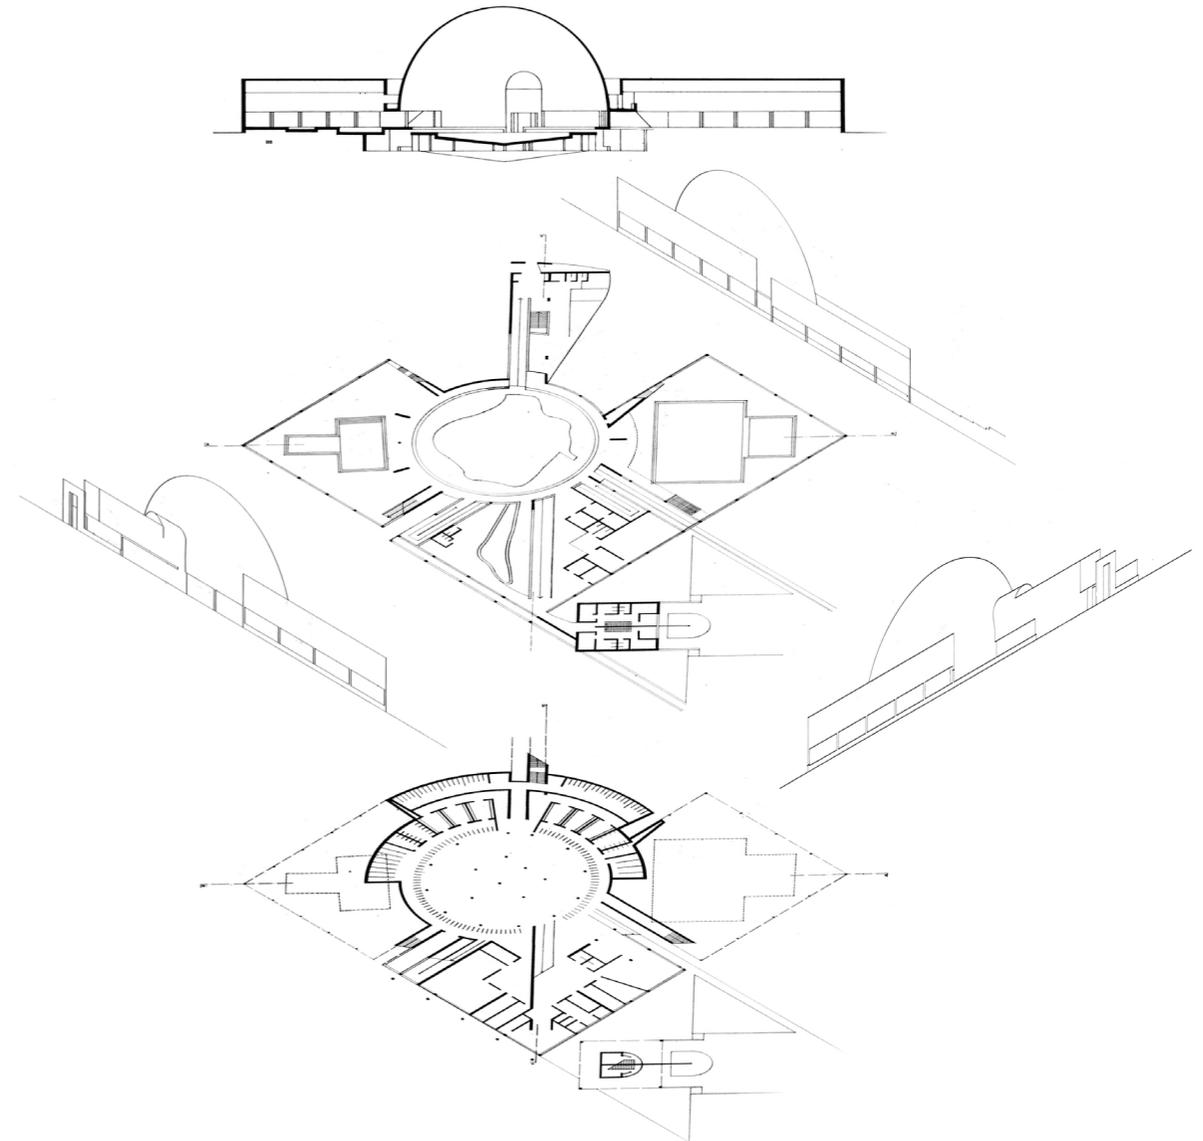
(página siguiente) Correspondencia diédrica entre la planimetría.
